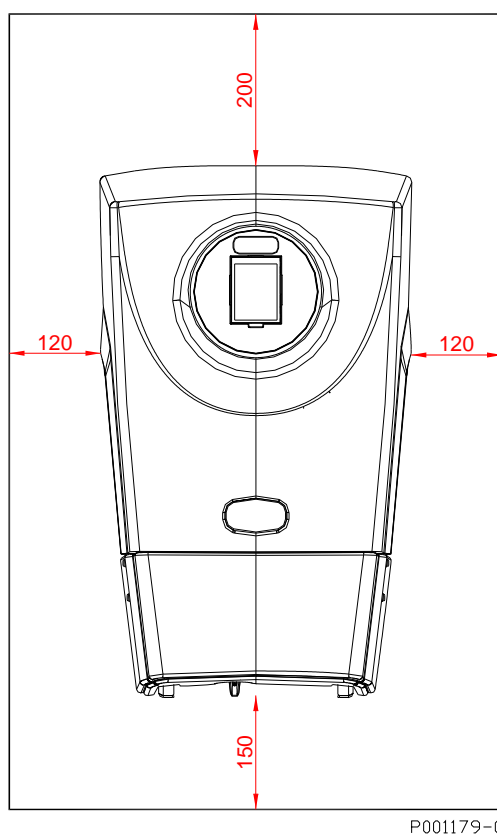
Spazi minimi da rispettare per un'efficace ventilazione dell'inverter SUNWAY M XS
